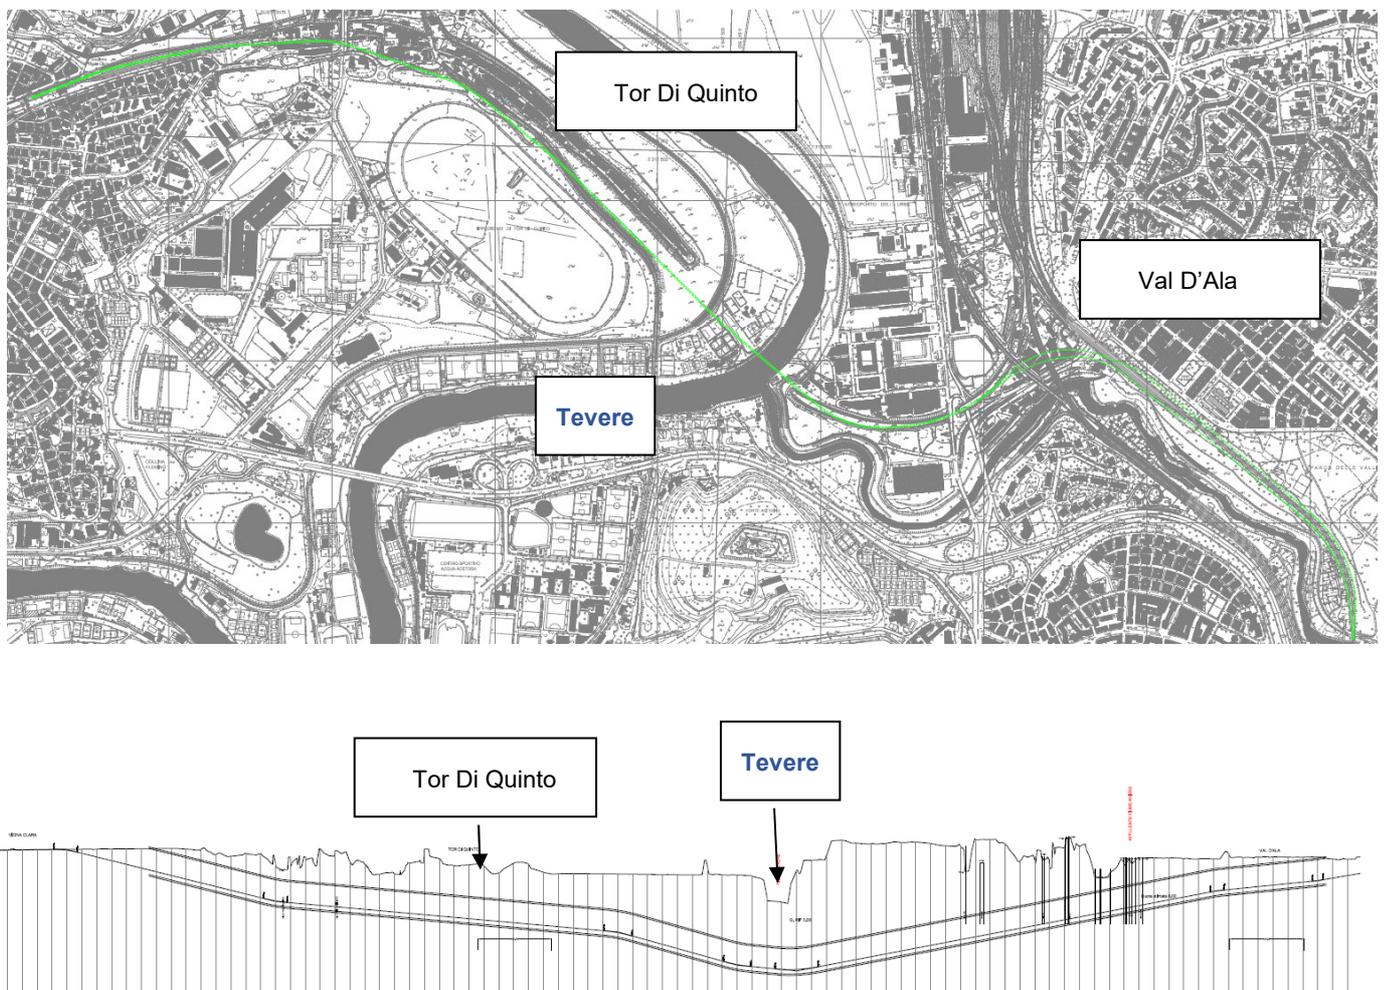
Planimetria e profilo soluzione totalmente in sotterraneo
